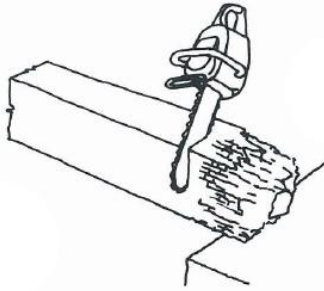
Corte da cabeça da viga (Arriaga) [21]
